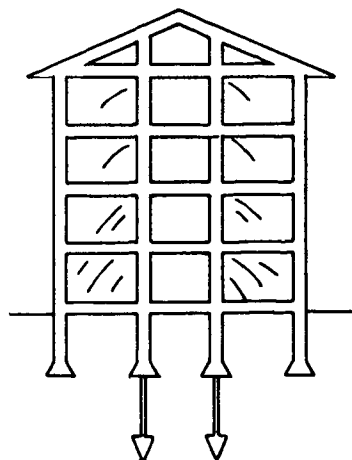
Caso de una estructura llena de hormigón; se han asentado fundaciones intermedias. Según Mastrodicasa.²⁹
